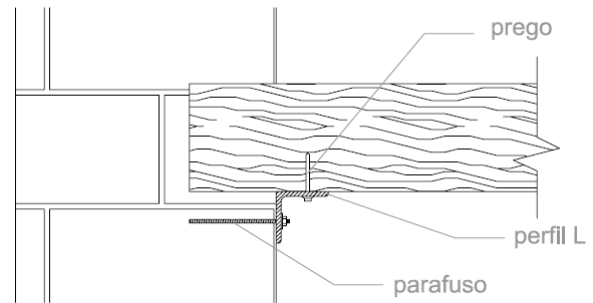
Viga embebida com fixação à parede através de cantoneira metálica.
